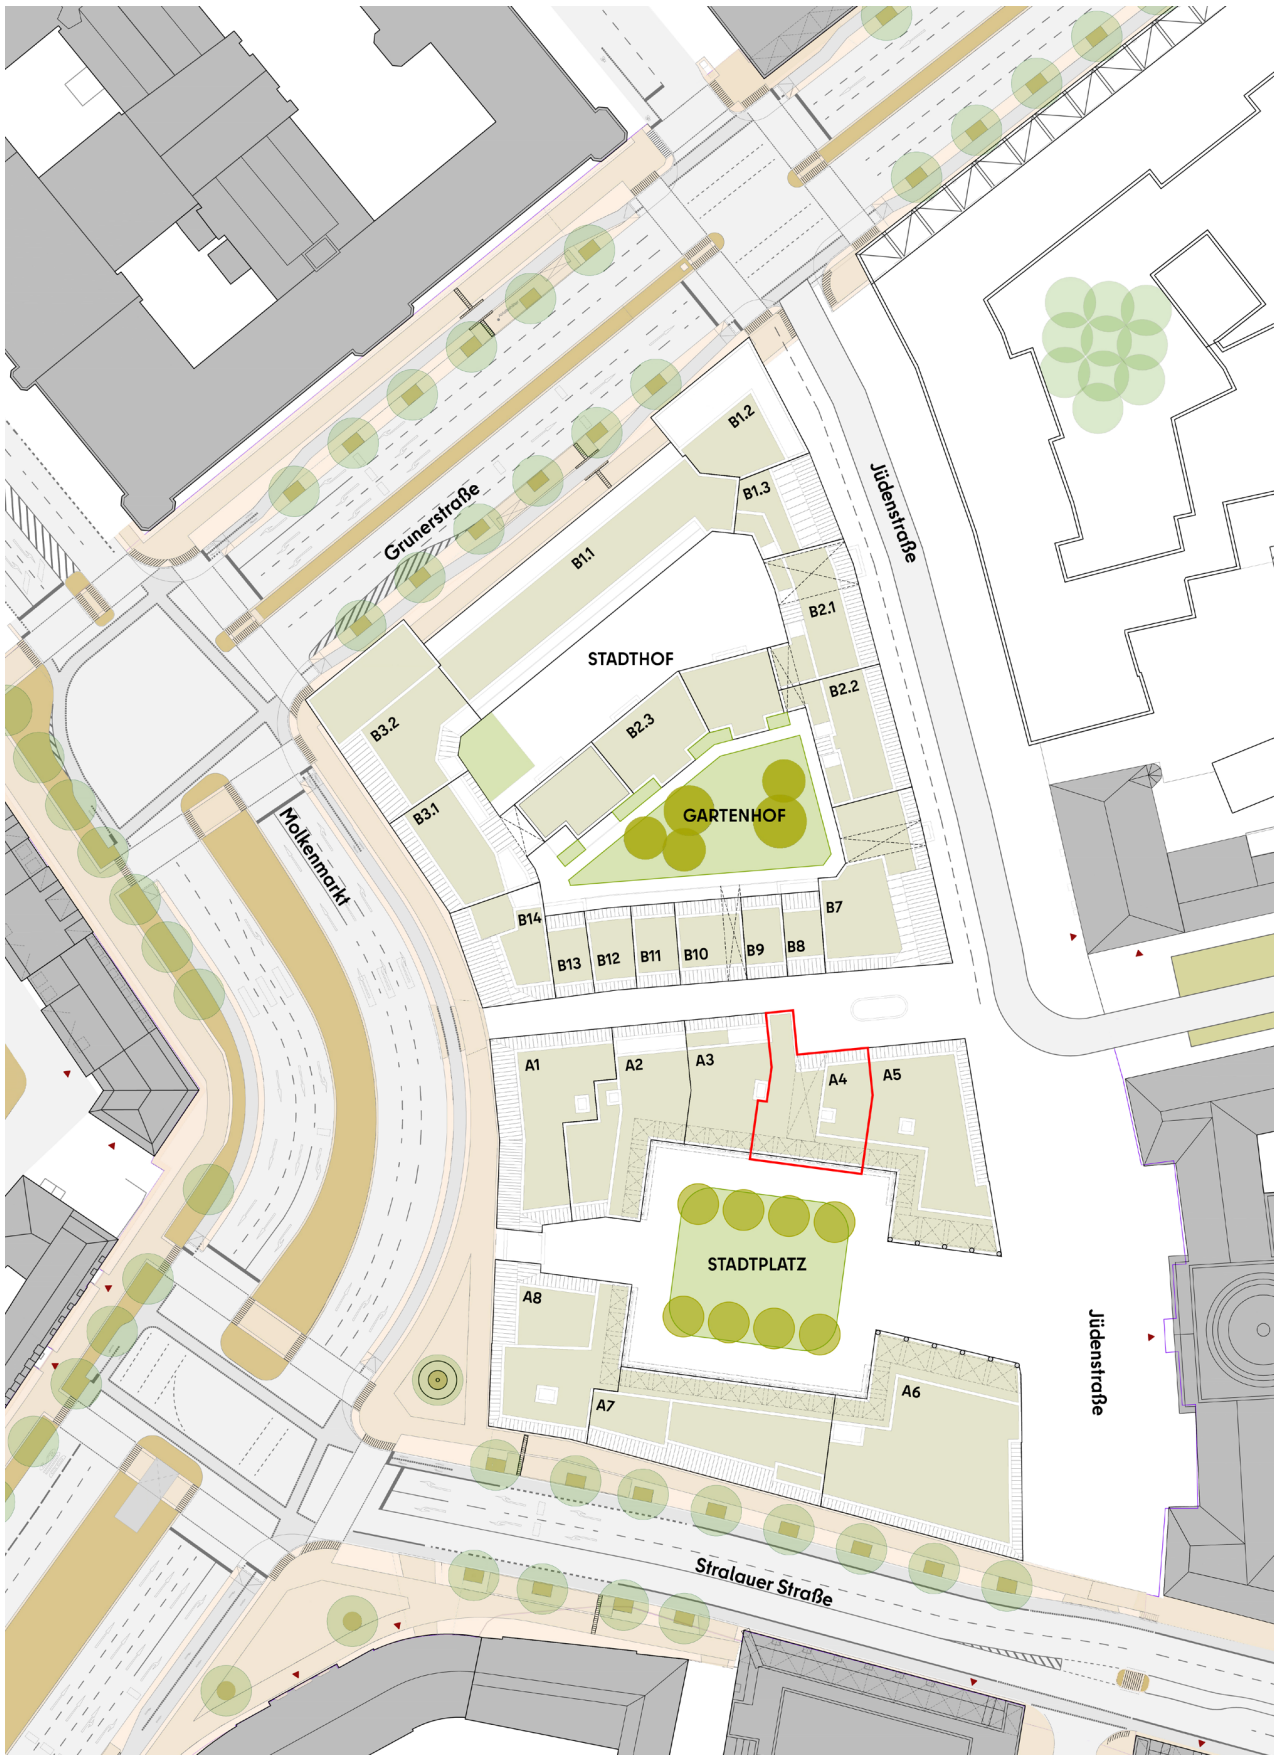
Dachaufsicht Block B mit Lage Haus A 4
